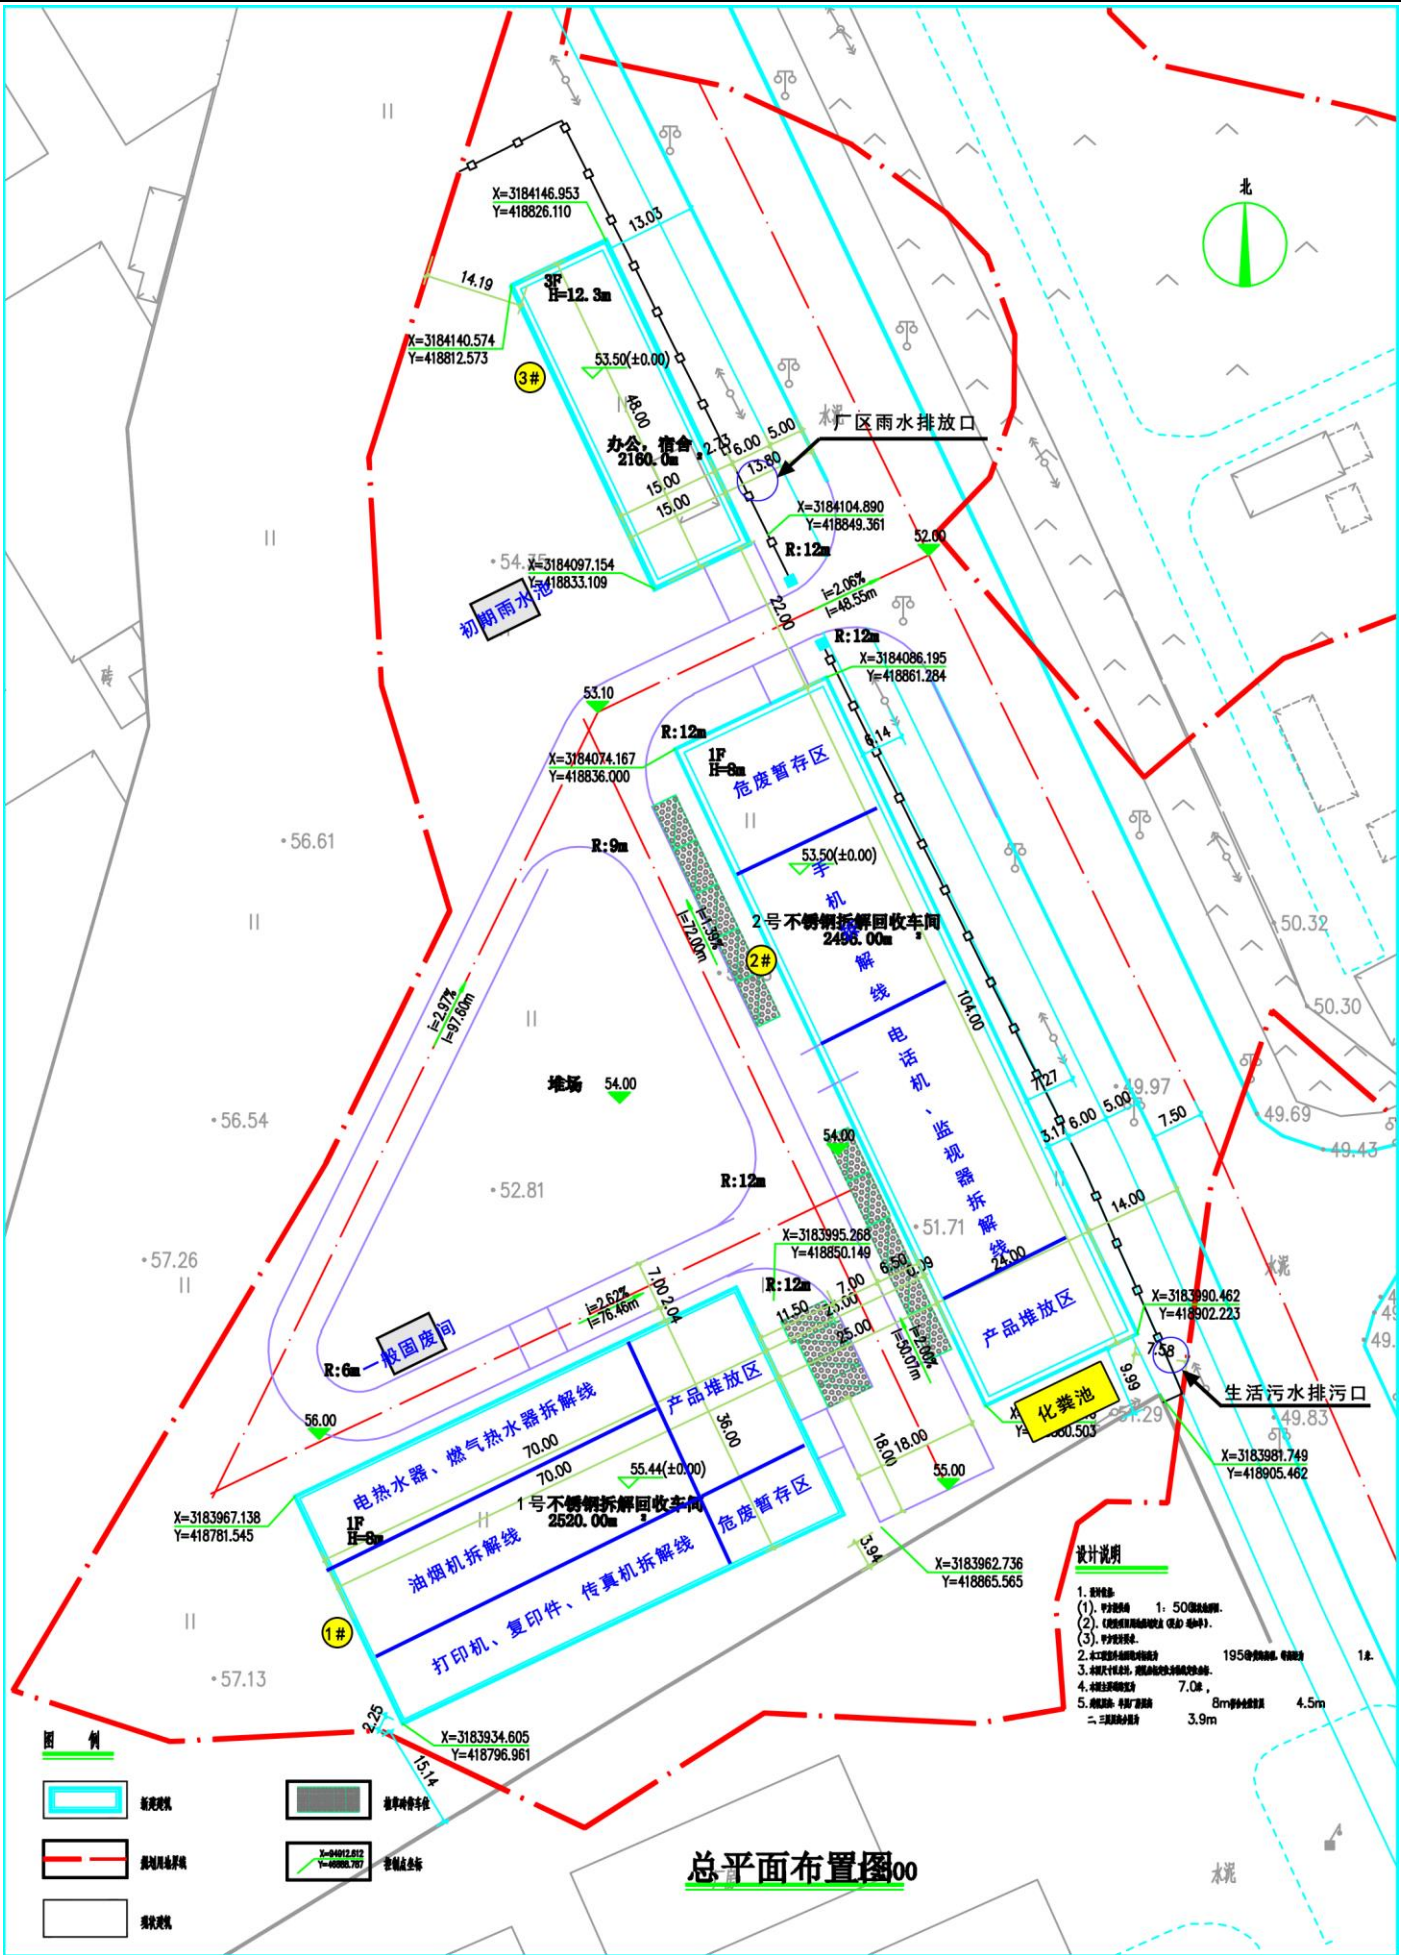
项目总平面布置图 (1#、2#、3#为排气筒编号)
